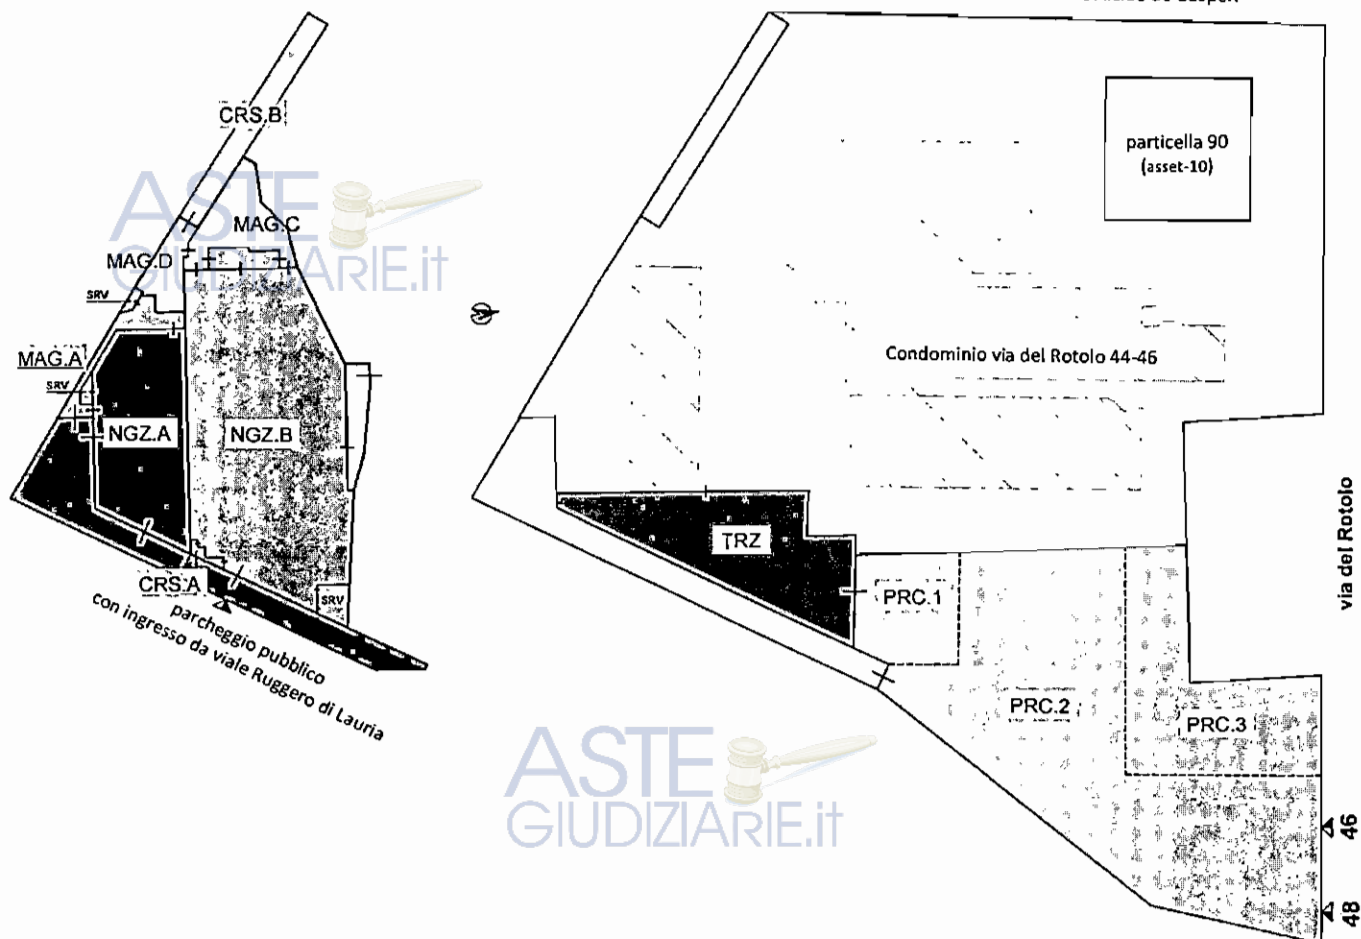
/2 -la distribuzione in pianta ai piani S1-T dell'asset edilizio n.04
